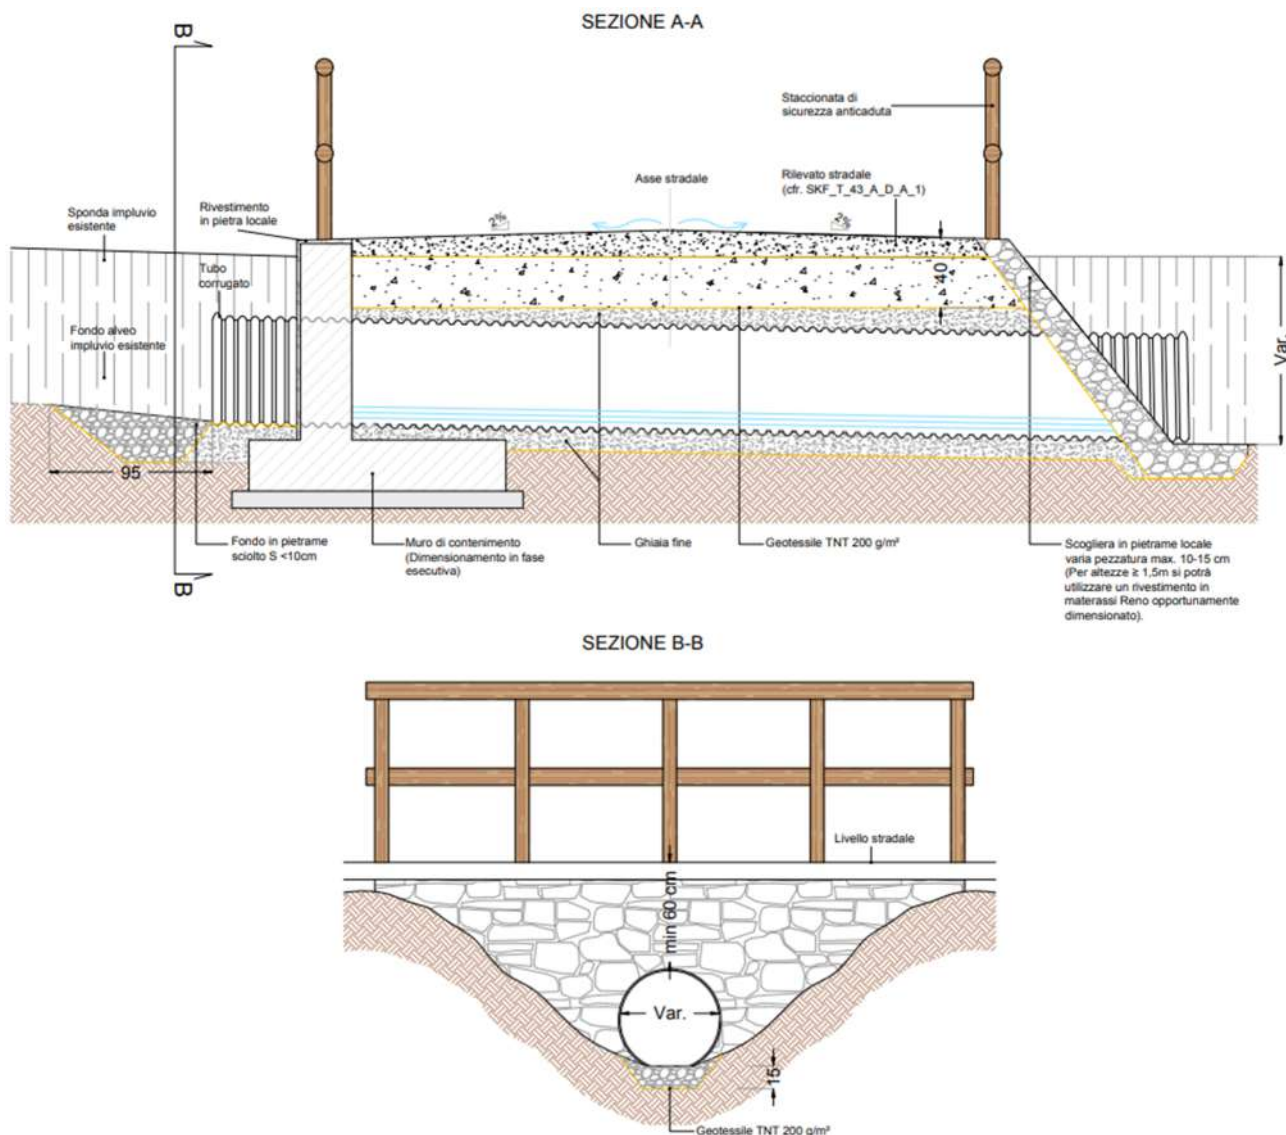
Opera di attraversamento idraulico, sezione trasversale e vista frontale lato monte (misure in cm)
